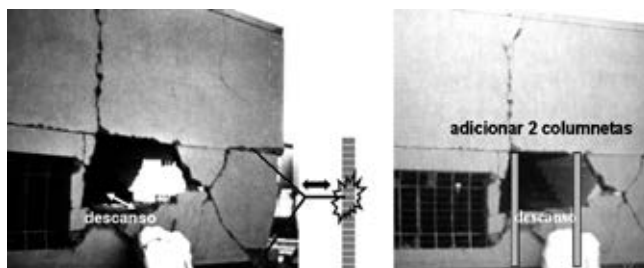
Falla por punzonamiento en la albañilería simple.
